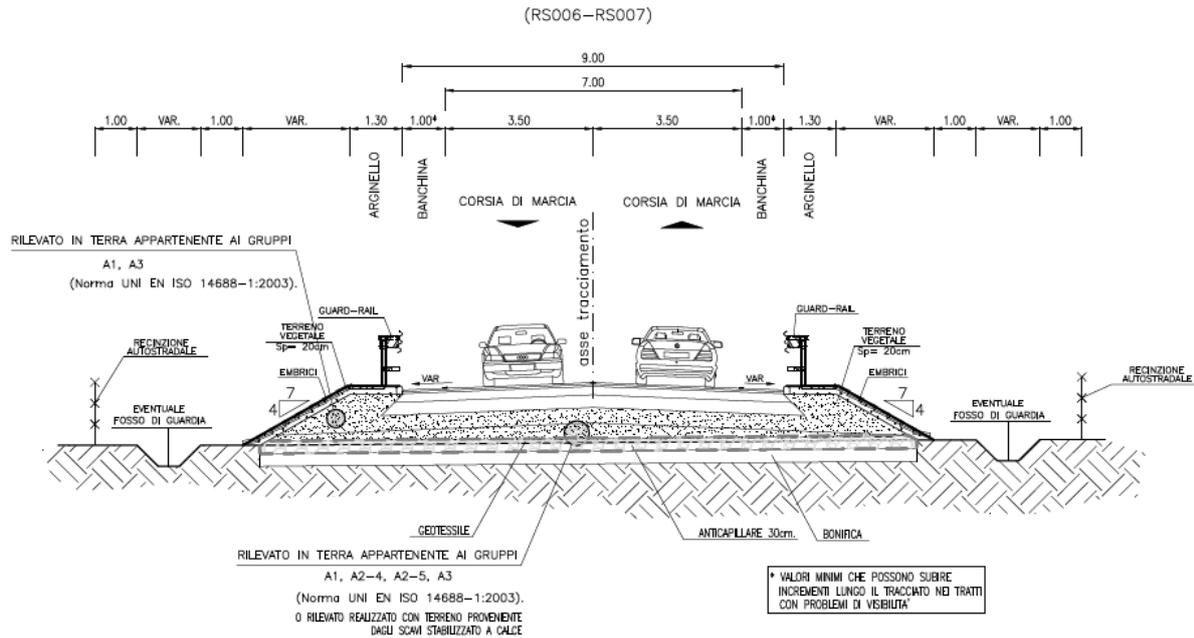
Sezione tipo rampa bidirezionale RS006-RS007
